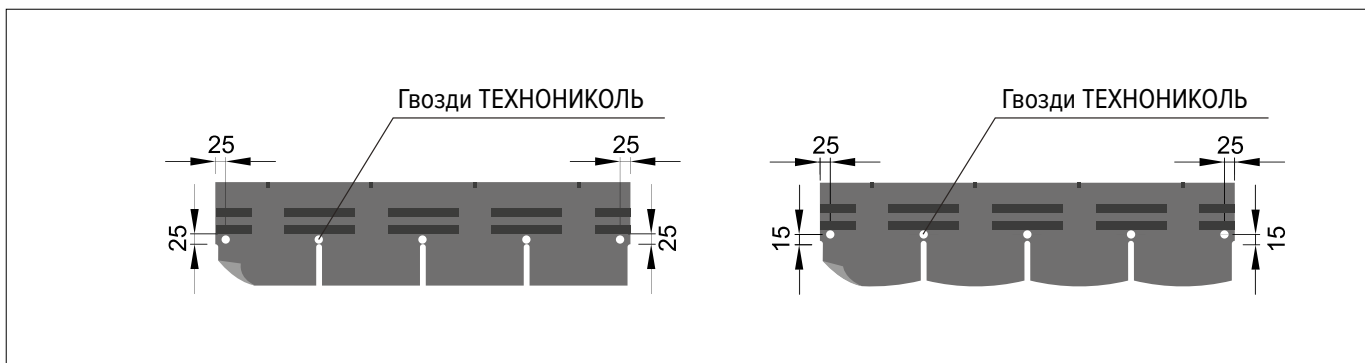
Схема крепления фасадной плитки на 5 гвоздей
